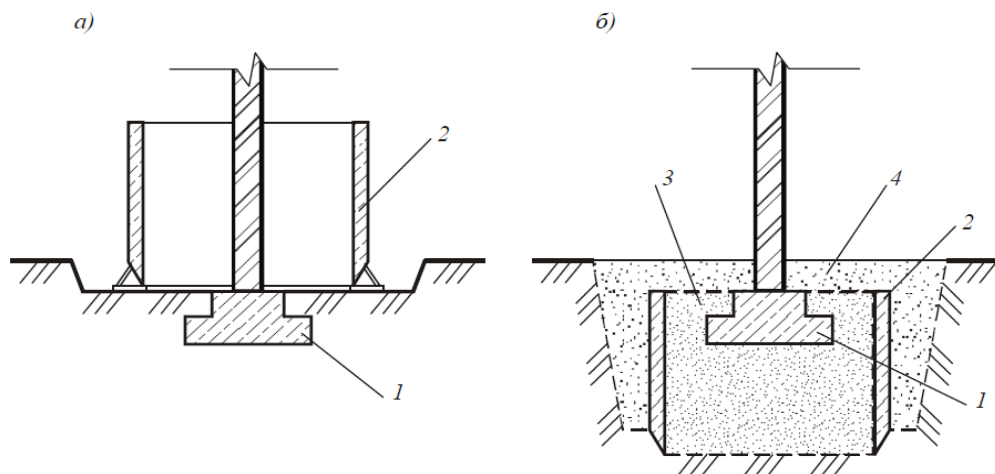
Усиление фундаментов с помощью опускного колодца:
